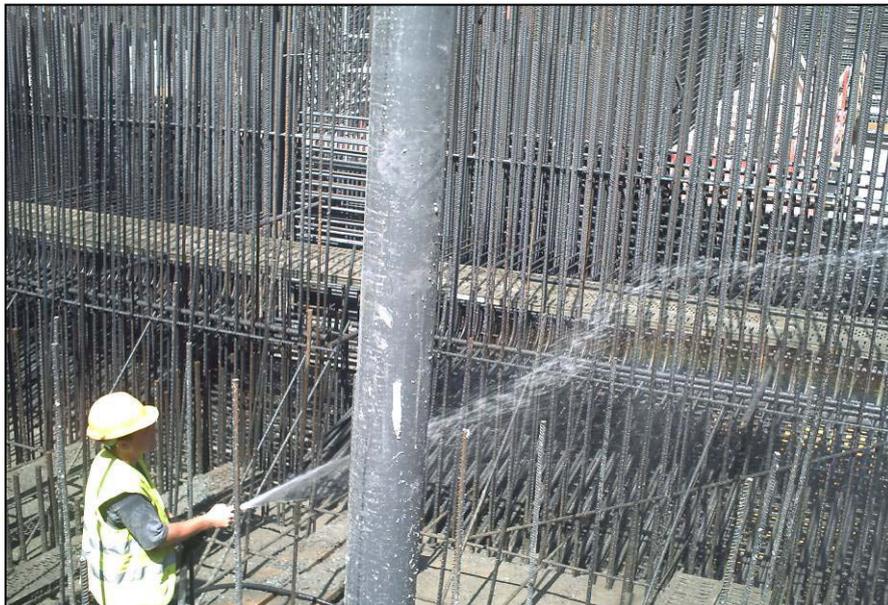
Central. Grupo 1. Fase intermédia da betonagem (devido à elevada temperatura procedeu-se à rega de cofragens e armaduras)
